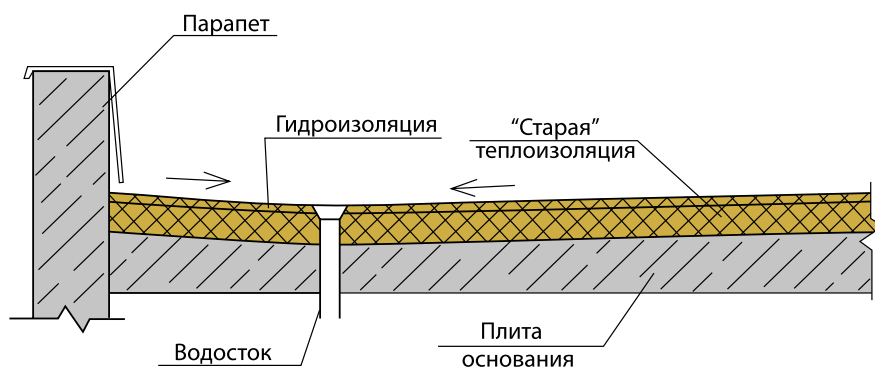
Конструкция неэксплуатируемой утепленной плоской крыши по железобетонной плите.
